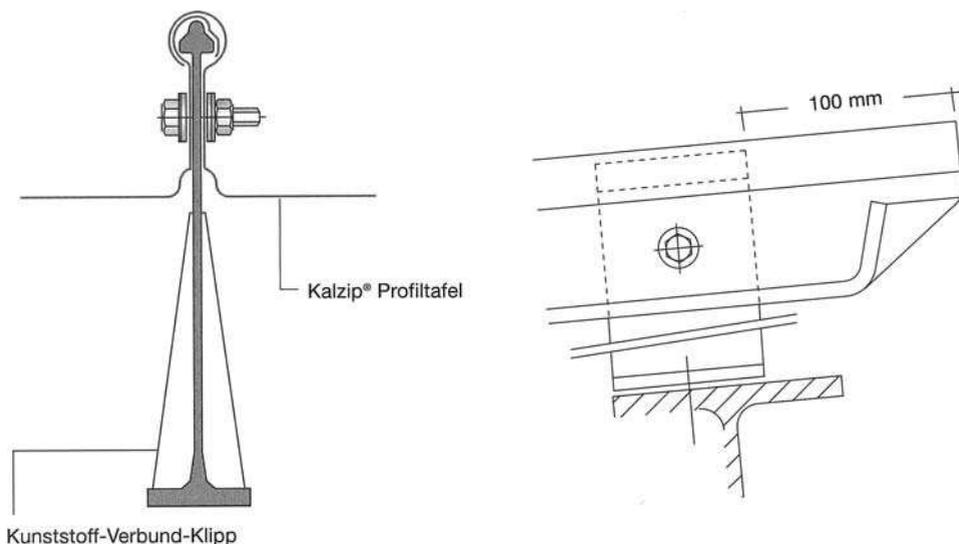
Berücksichtigung der Kräfte aus dem Dachschub am Fixpunkt
